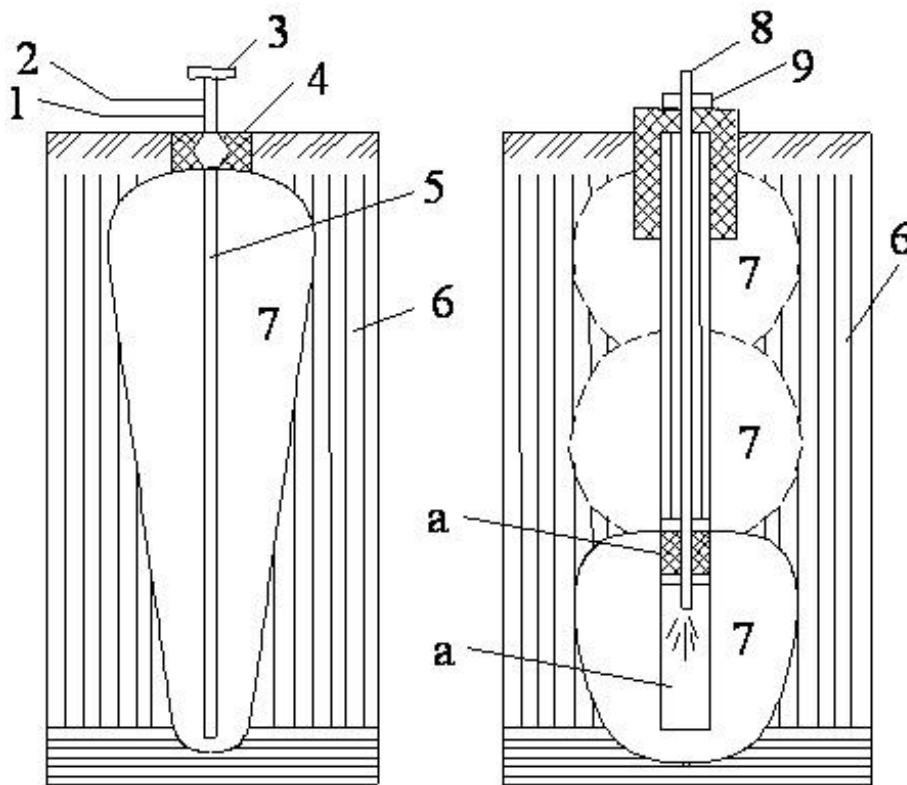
Схеми термічного закріплення ґрунтів: а – при спалюванні палива в гирлі свердловини; б – при пересуванні камери згорання вздовж свердловини:
